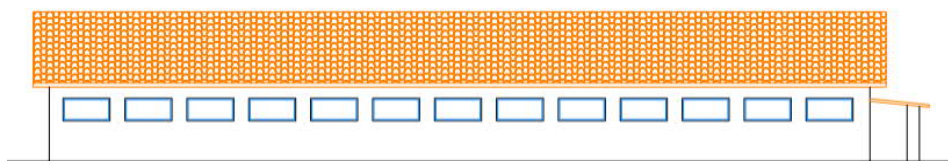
Prospetto Sud/Ovest porcilaia quarantena (estratto tavola 9)
